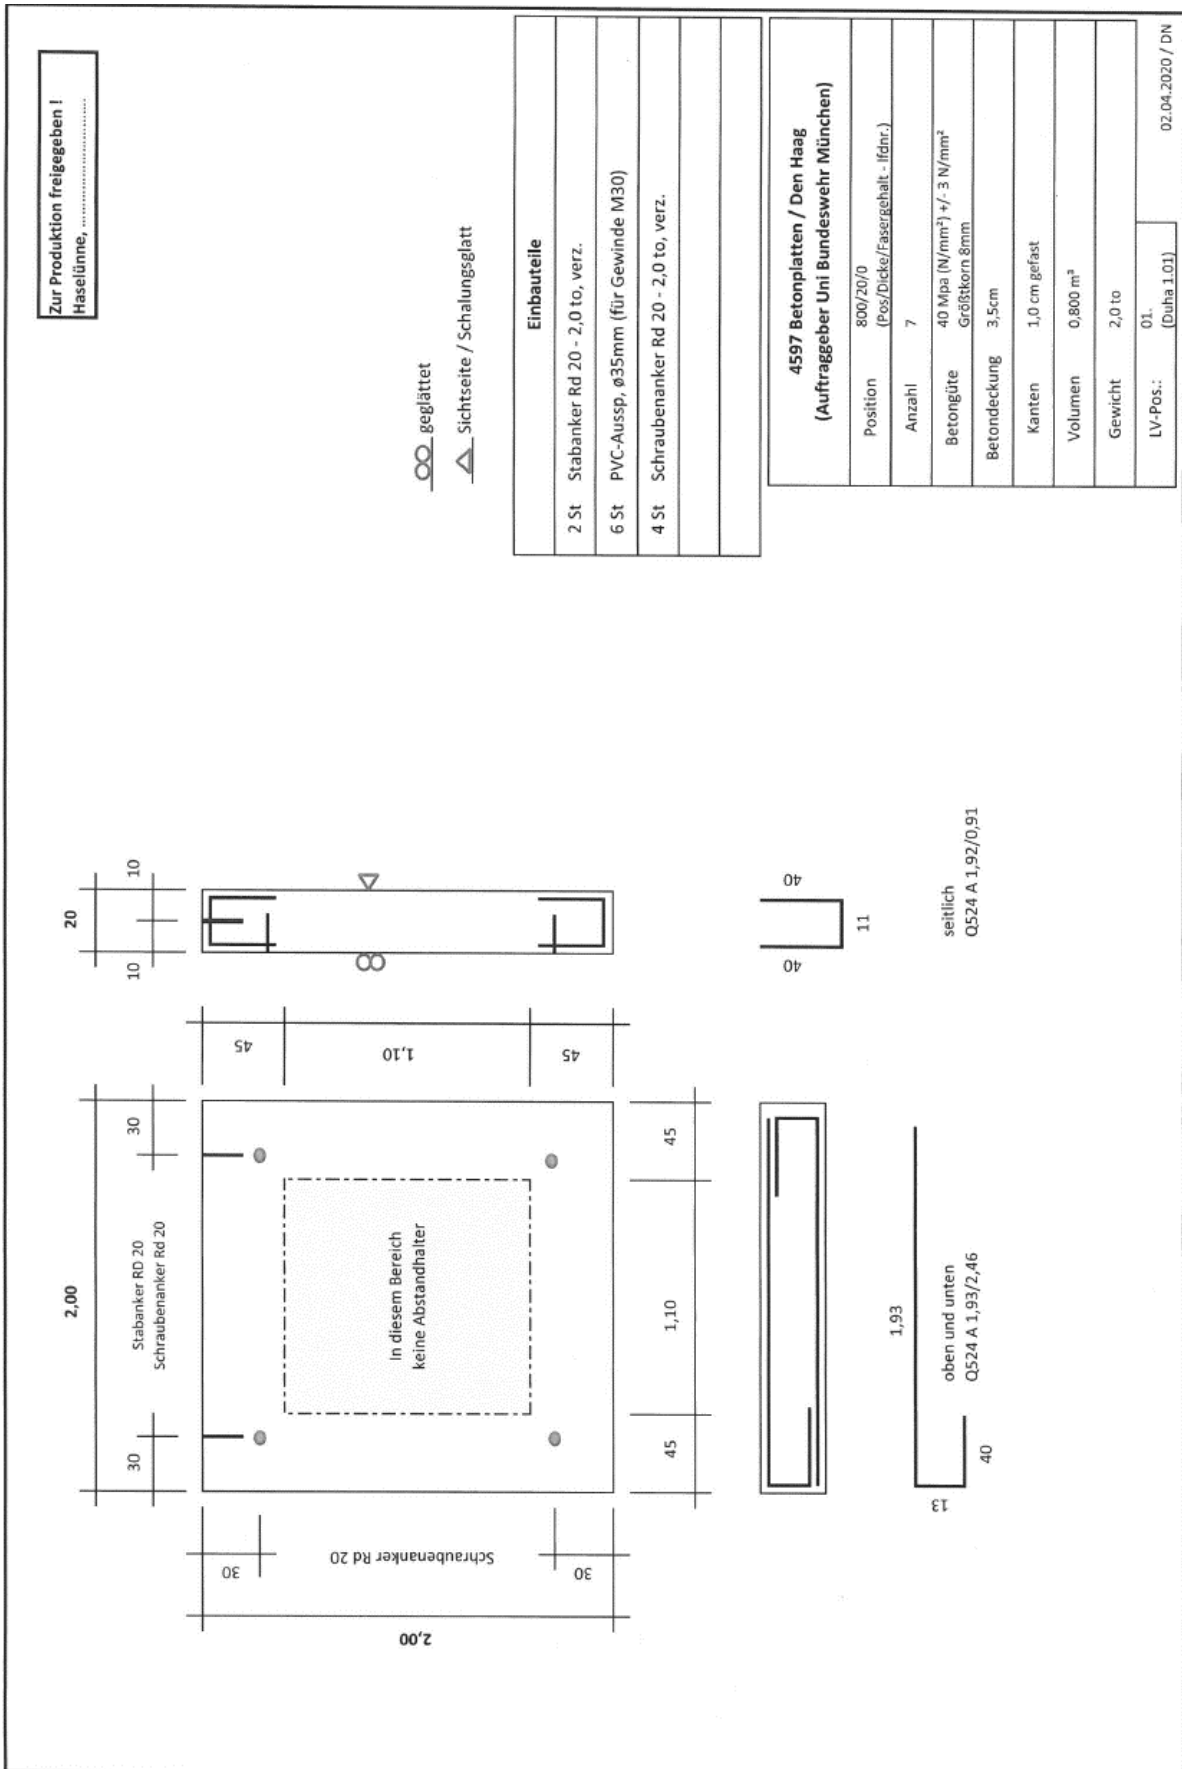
Bewehrungsplan für Stahlbetonplatten (d = 20 cm).
